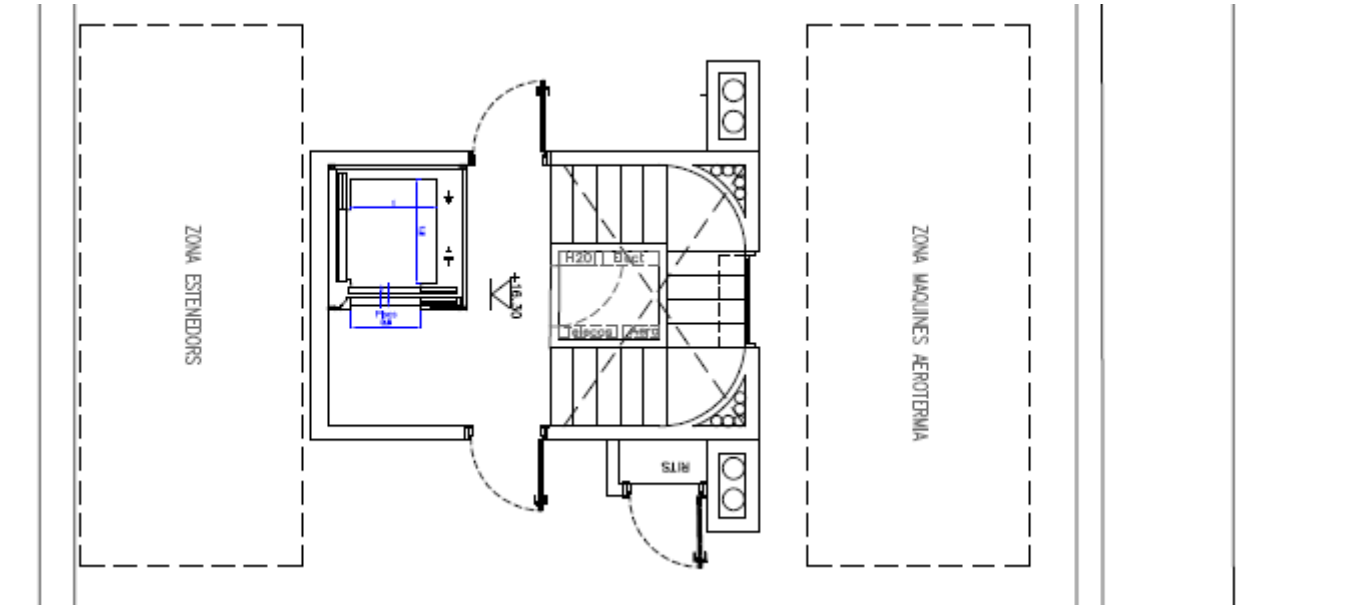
Detall de la proposta de planta coberta(Annex 3)
